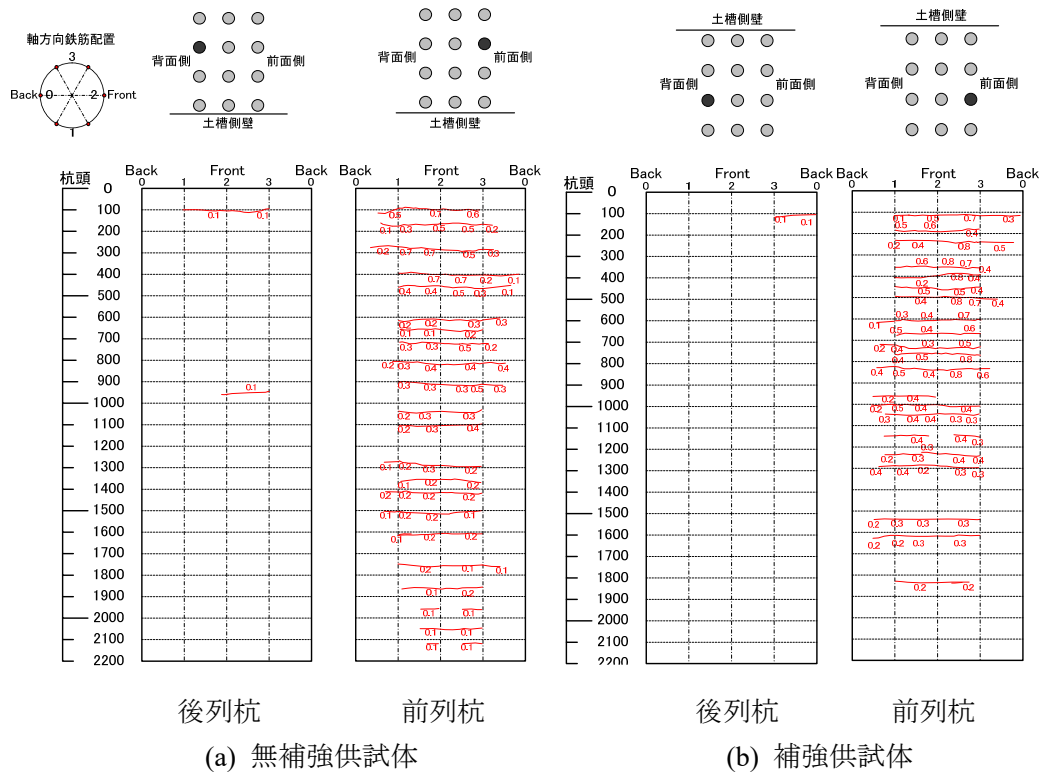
既設杭のひび割れ状況展開図[単位：mm]
